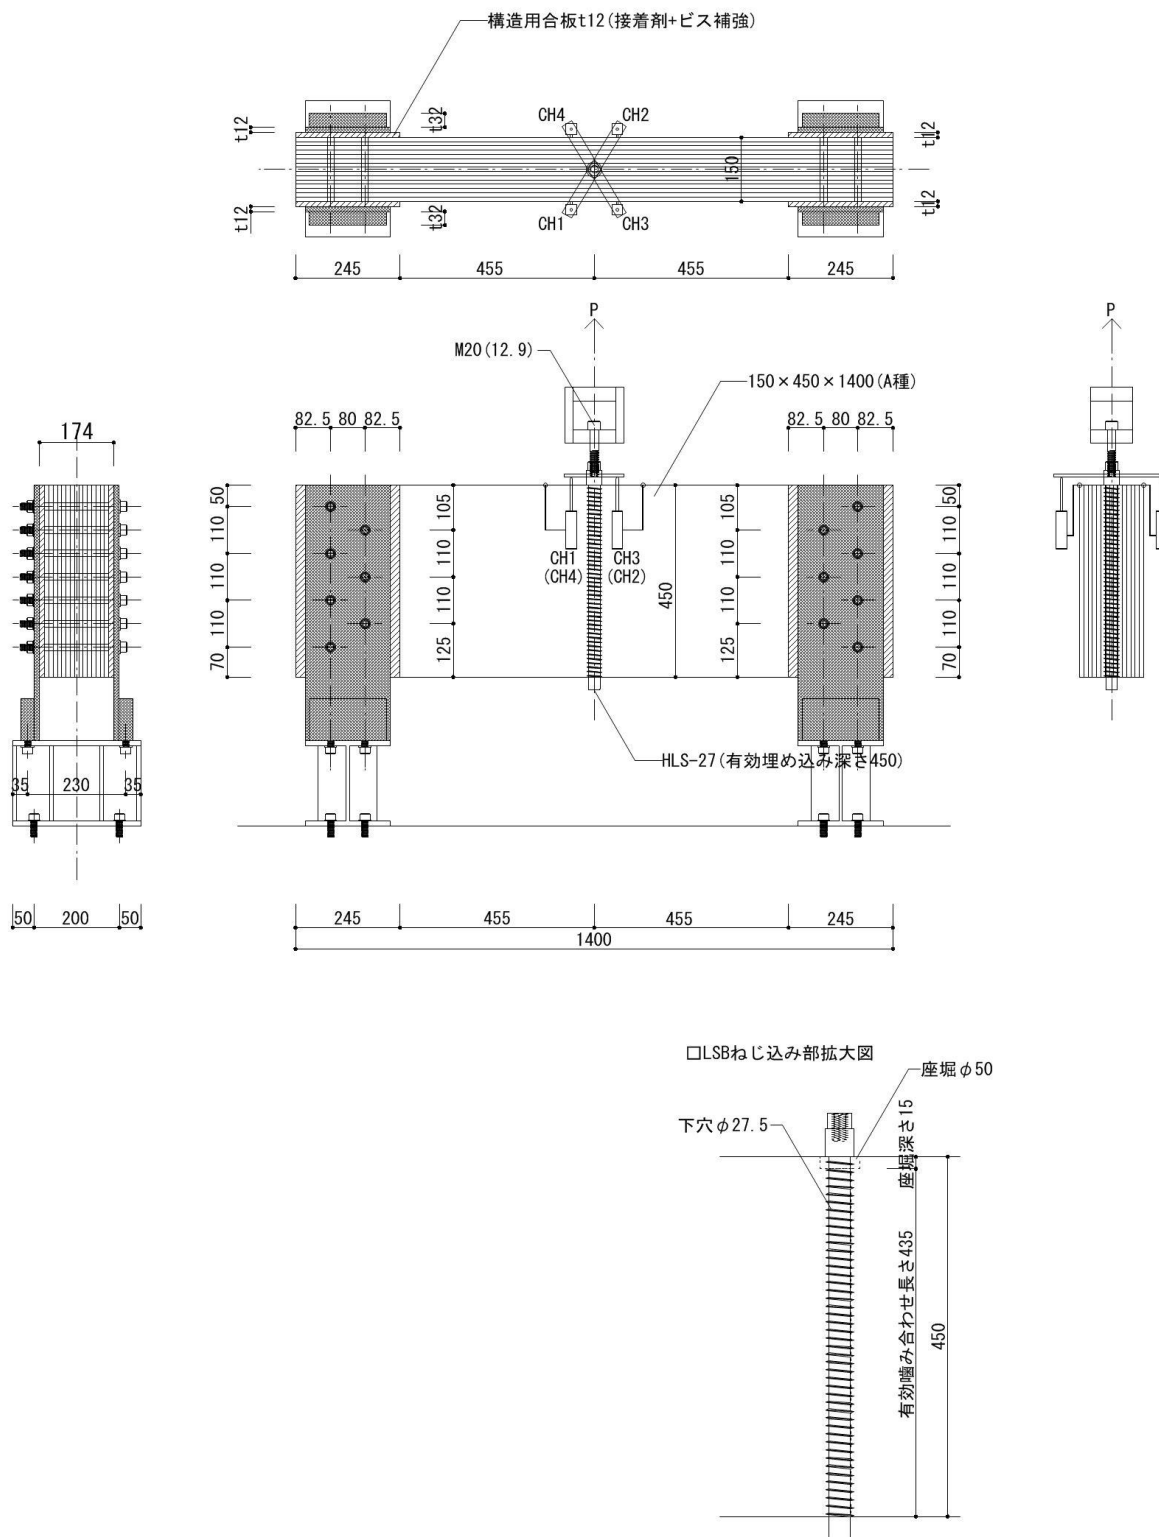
試験体の形状及び寸法 (C-3)
